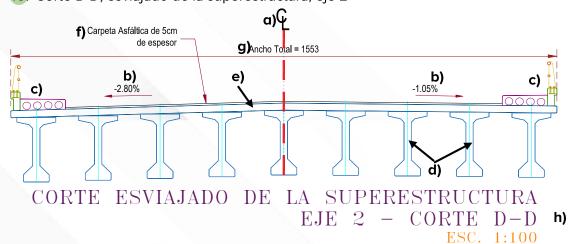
Corte D-D, esviajado de la superestructura, eje 2
